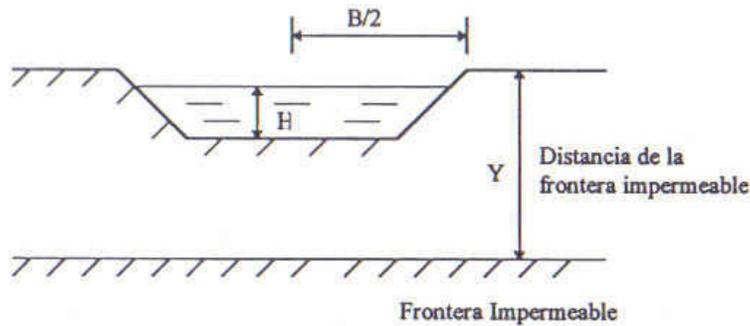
Corte de la zanja utilizada en la prueba tipo Matsuo⁽⁸⁾
